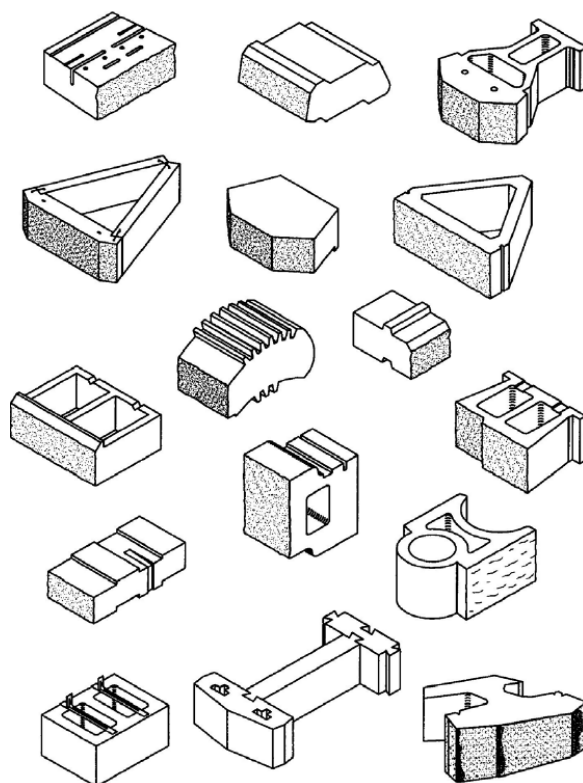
Unidades de bloques modulares de fachada de muros de suelo reforzado.
